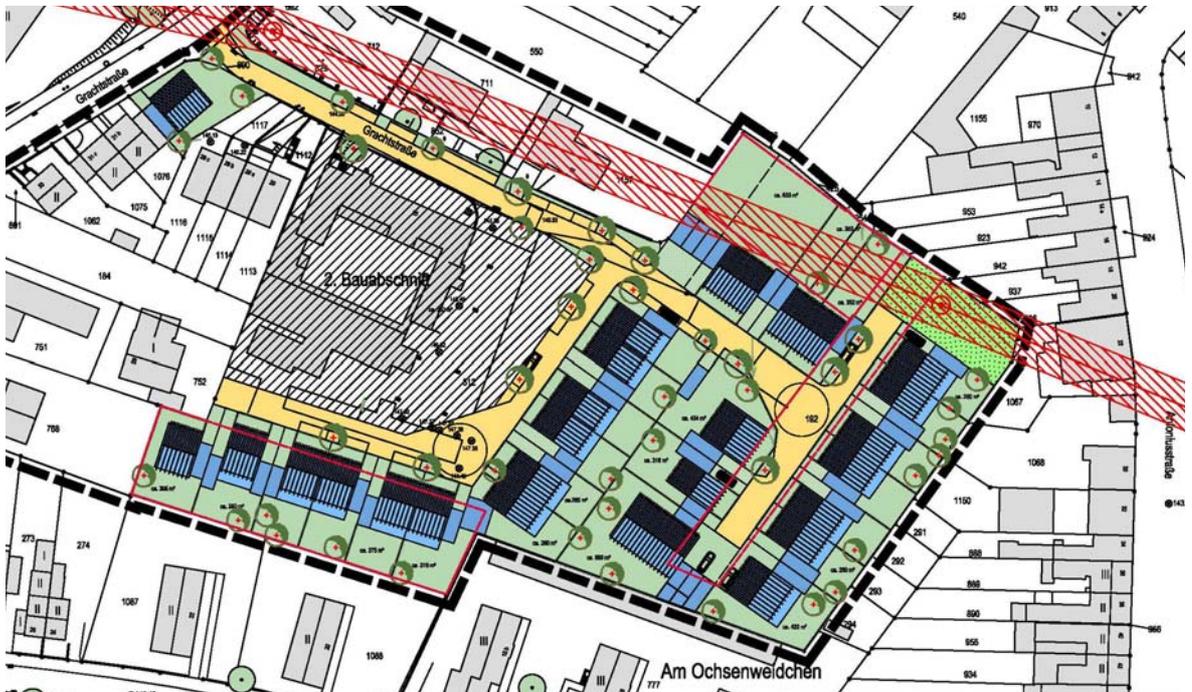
Entwurfsvariante II, dargestellt ist der 1. Bauabschnitt mit 5 EH, 18 DHH und 2 MFH
